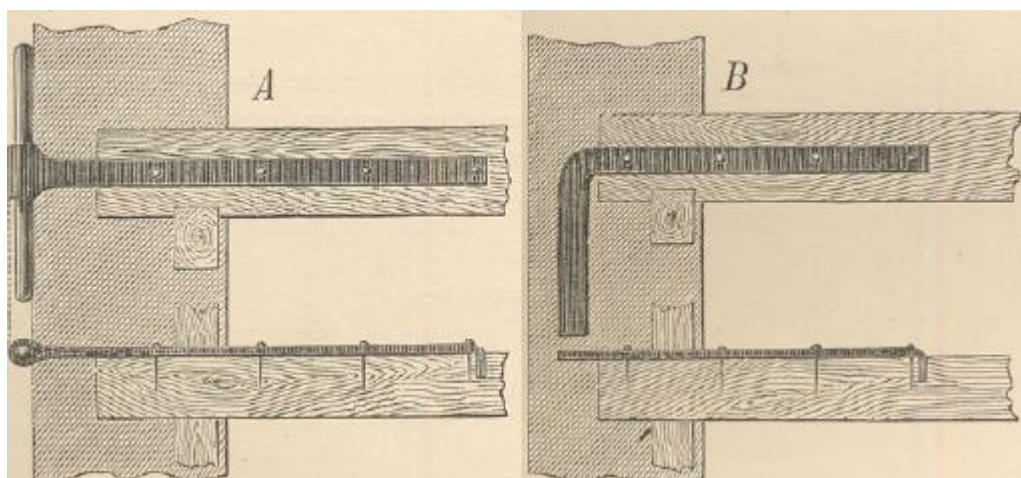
Tipos de ligação entre as vigas de pavimento e as paredes exteriores. A - ferrolho de chaveta; B - ferrolho de esquadro [8].
